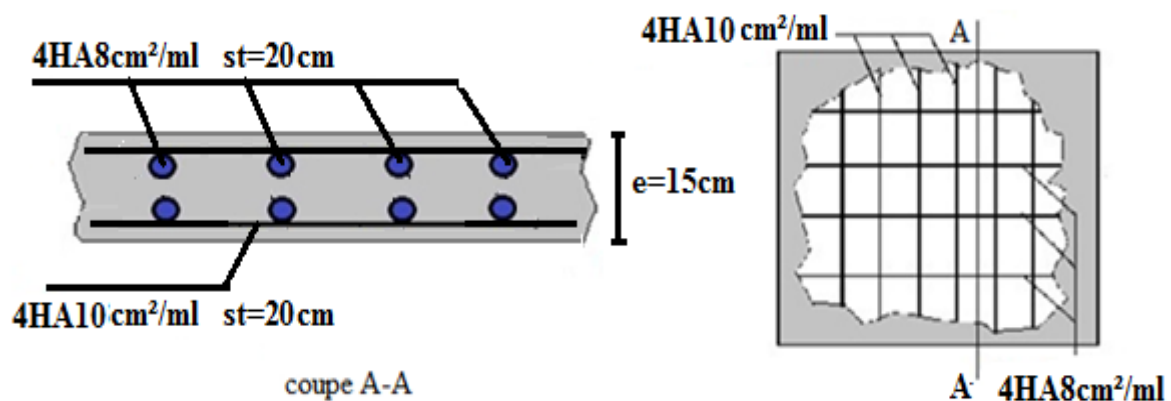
Schéma de ferrailage de la dalle en cas de charge concentrée
